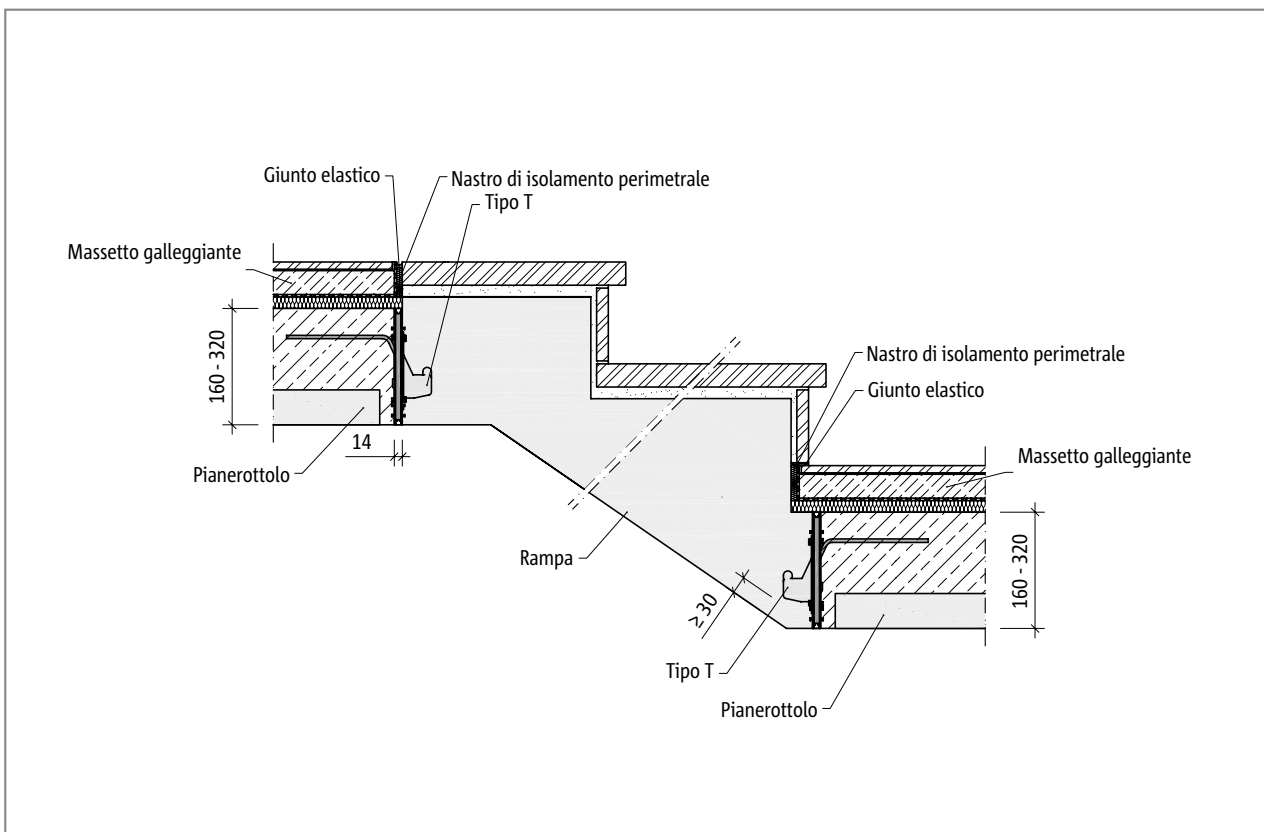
Schöck Tronsole® tipo T: Sezione costruttiva - costruzione prefabbricata
